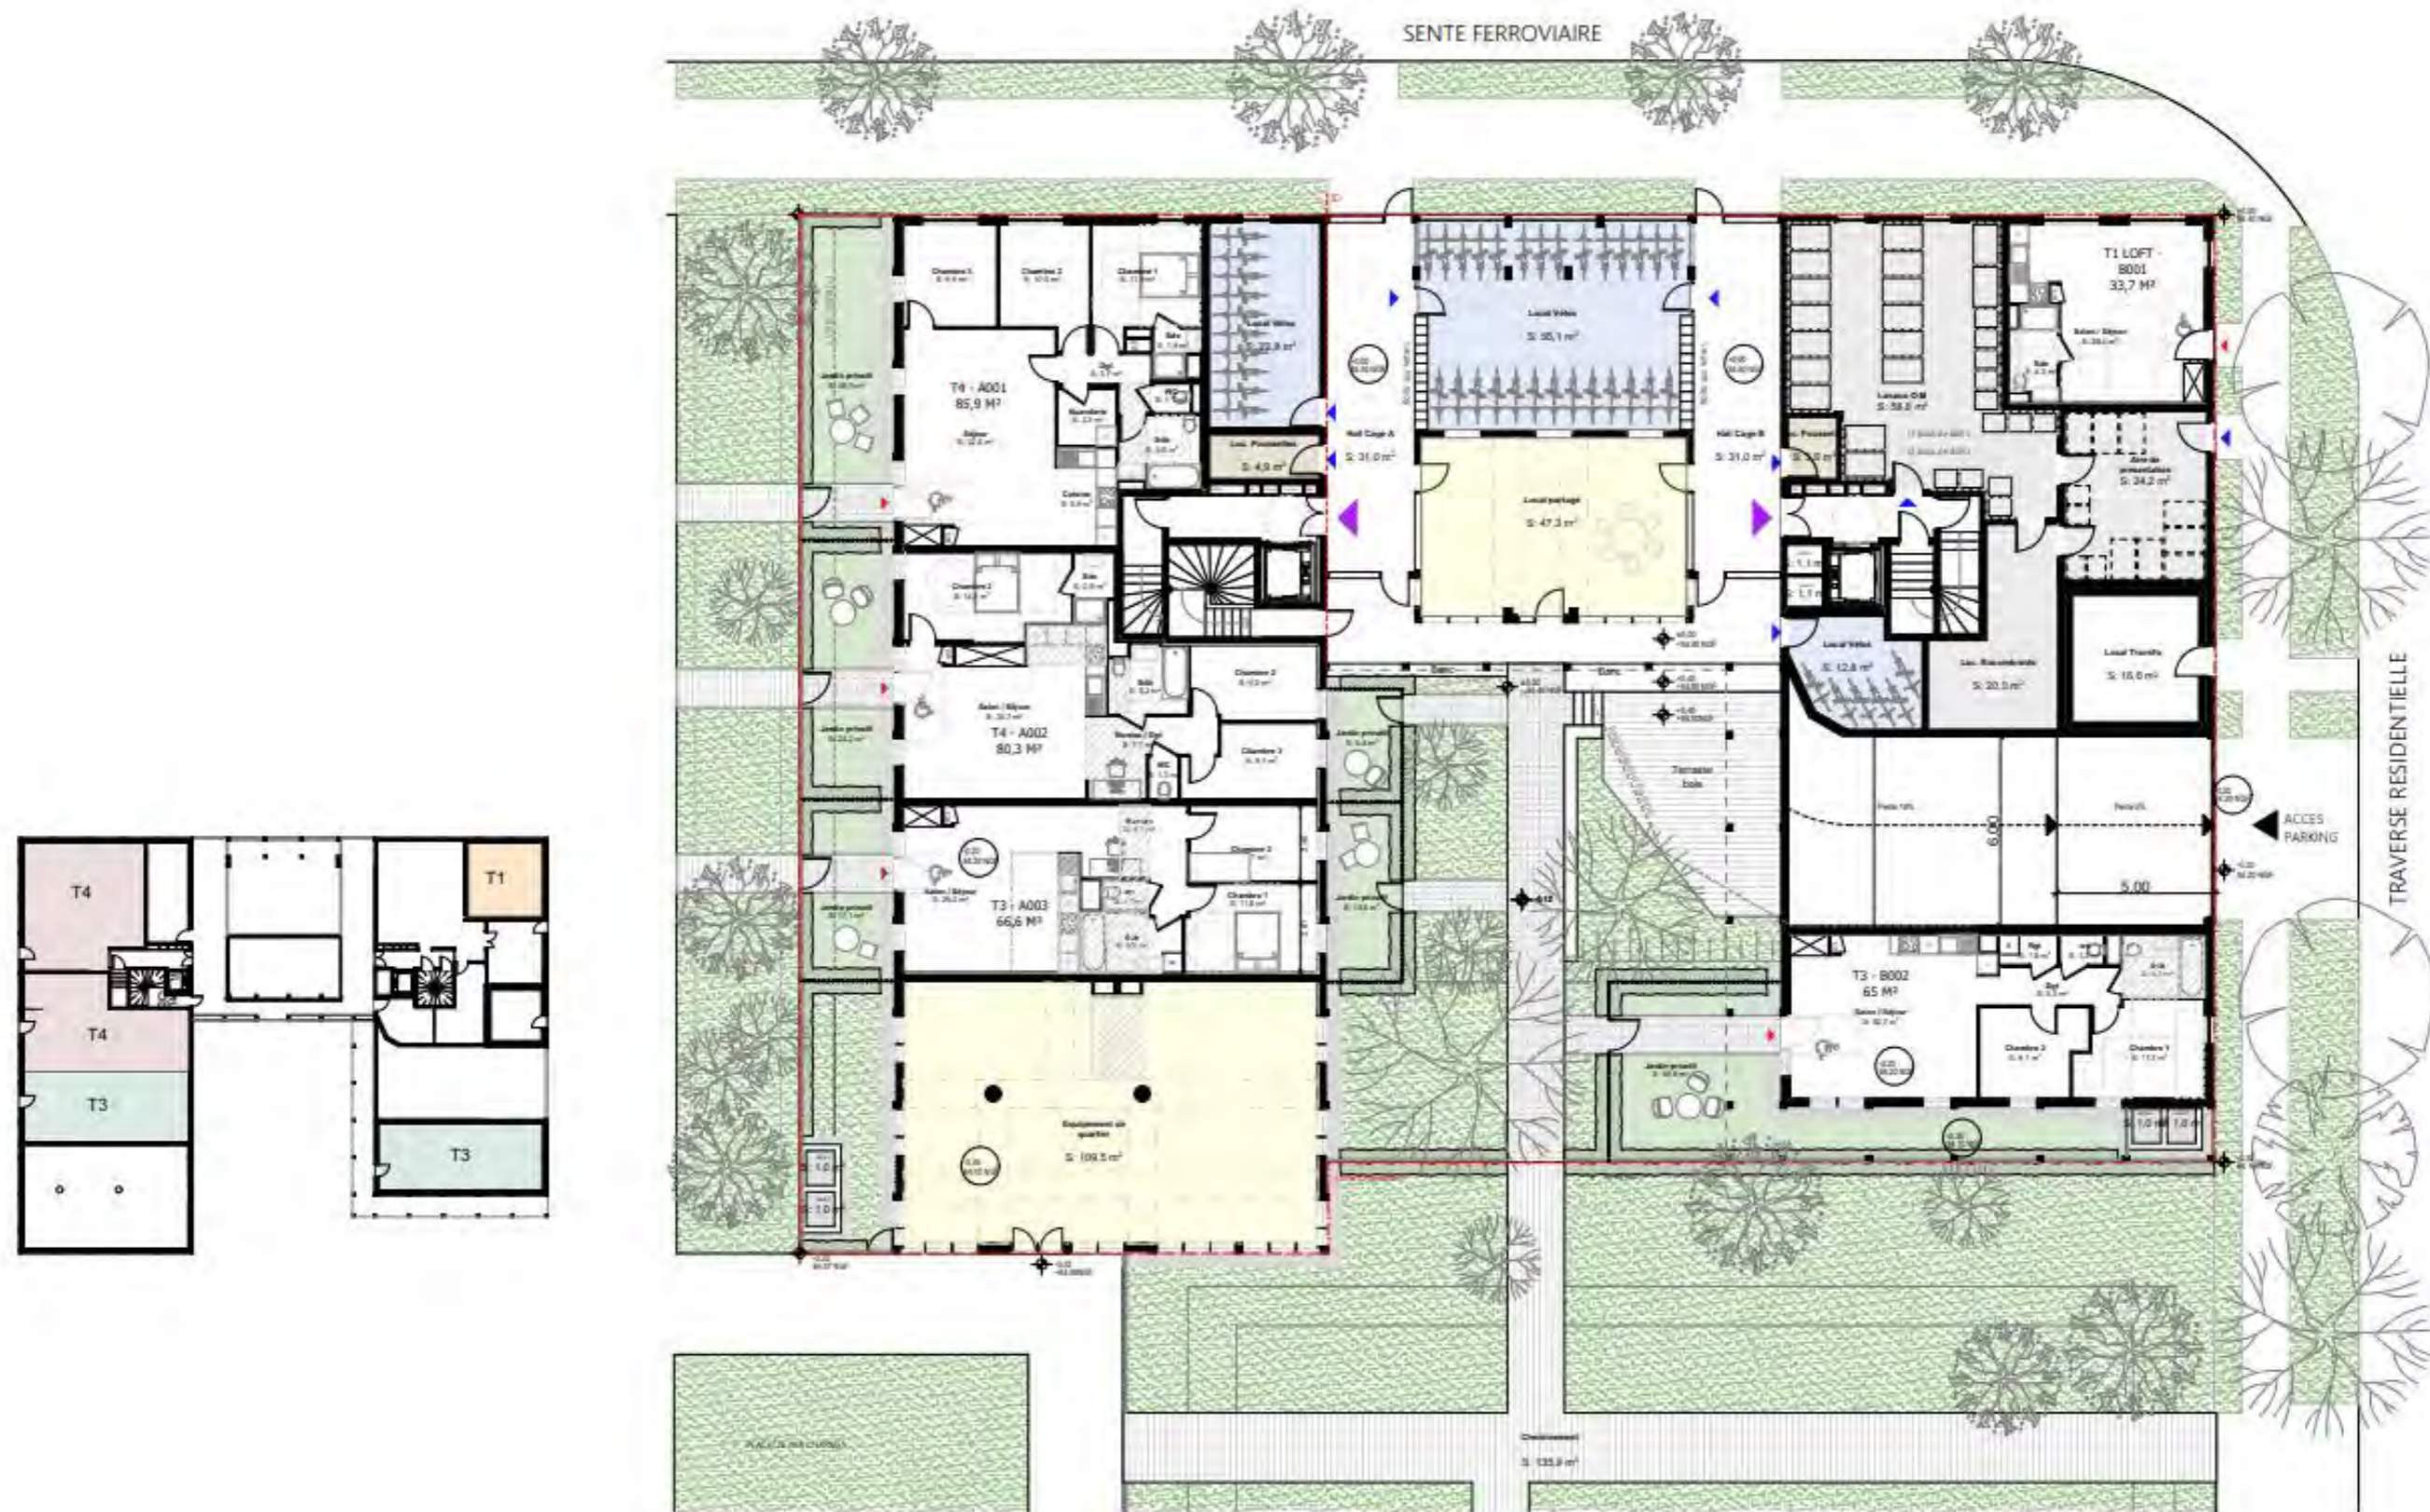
Plan masse du RDC des bâtiments du lot 4.2
